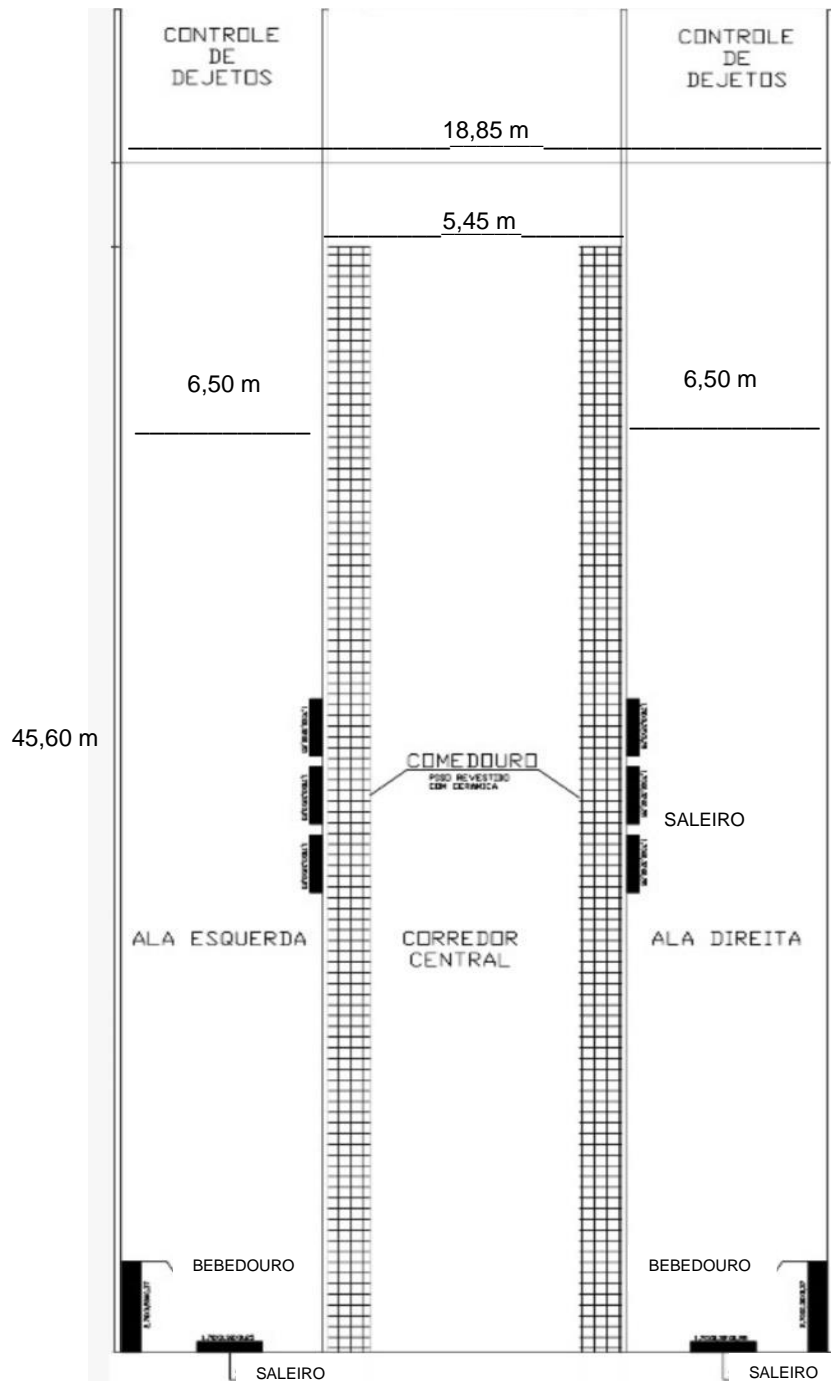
Planta baixa da instalação do *free stall* Unicesumar.
